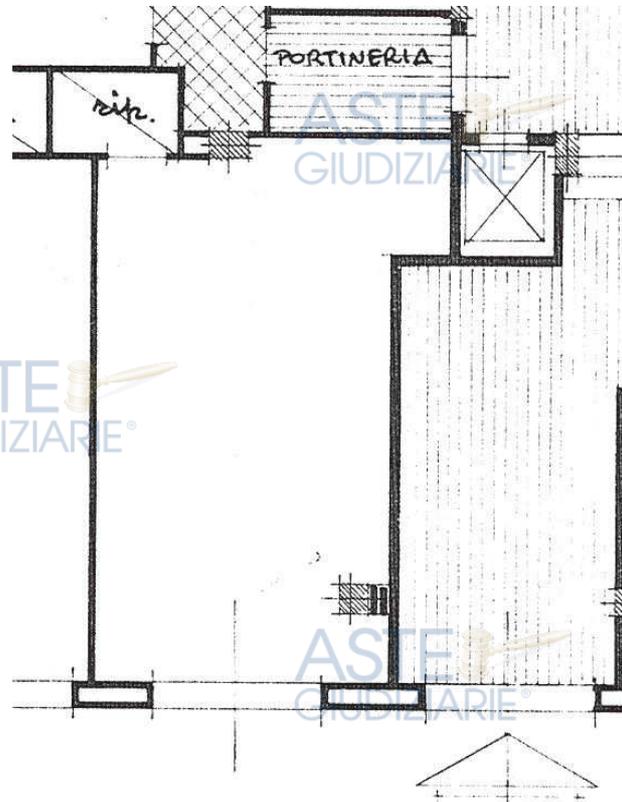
Grafico dell' Autorizzazione edilizia del 09/05/1963
